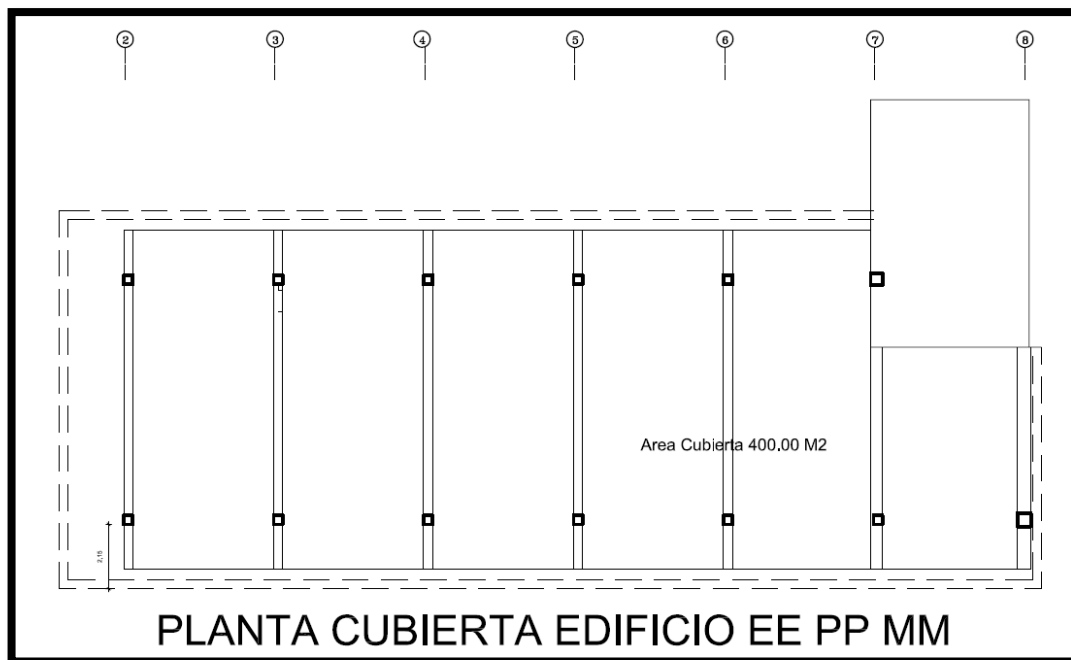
Plano de la Cubierta del Edificio EEPPMM
